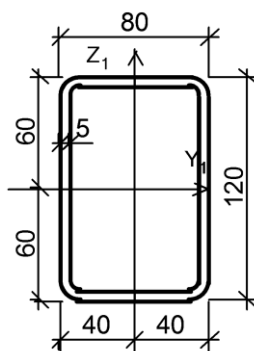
Поперечное сечение верхнего пояса фермы
